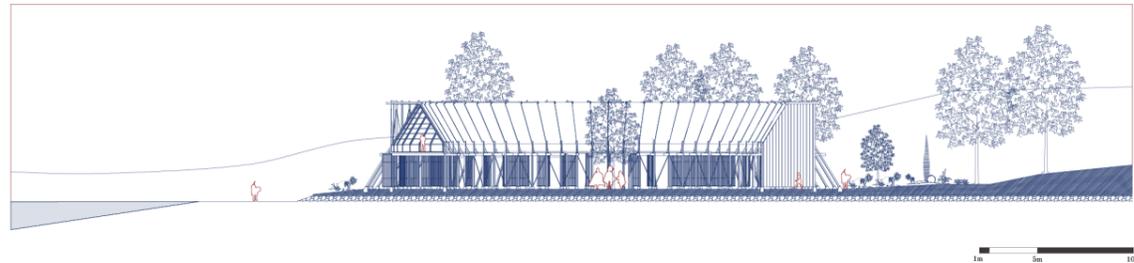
Corte AA' Oeste - Este. Fuente: Elaboración propia
